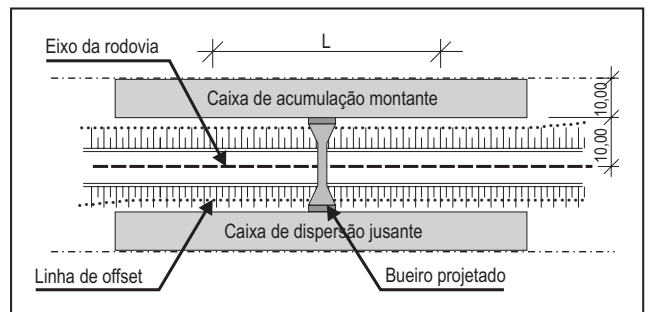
Caixas de acumulação e dispersão – Vista em planta
